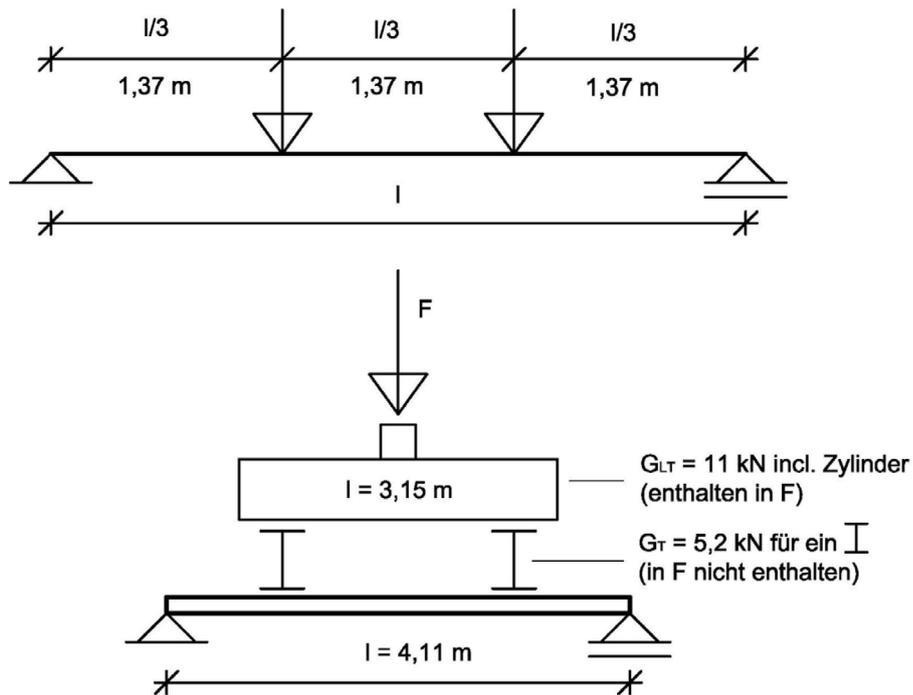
Belastungsanordnung und Einrichtung Stahlbetondeckenplatte 21120
